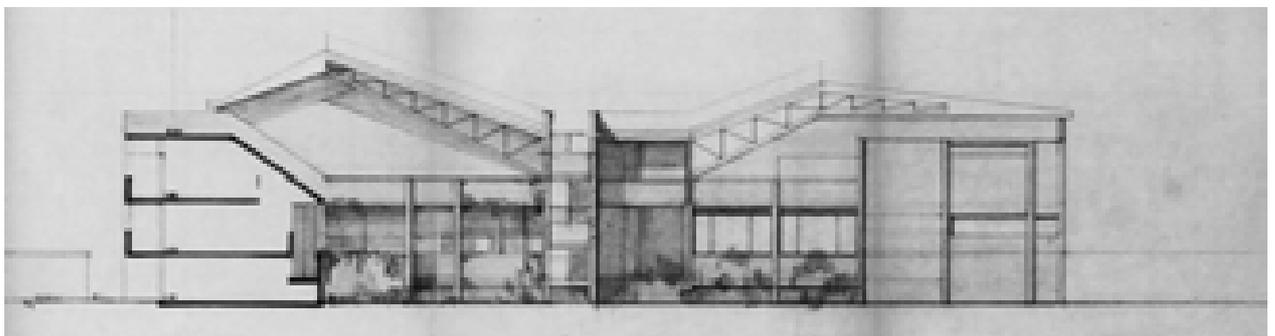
Prospetto Sud, stato futuro – 15/01/1977 (AABS-1996.700)
